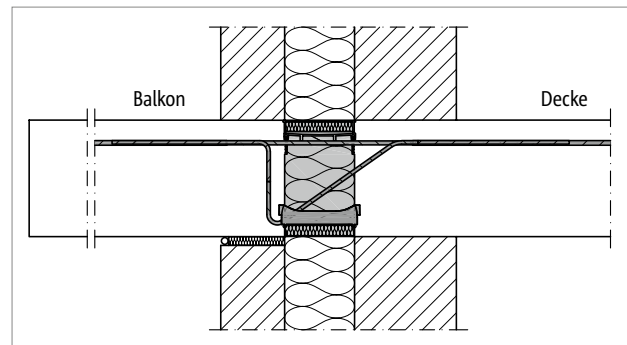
Schöck Isokorb® XT Typ KL: Anschluss bei zweischaligem Mauerwerk mit Kerndämmung
